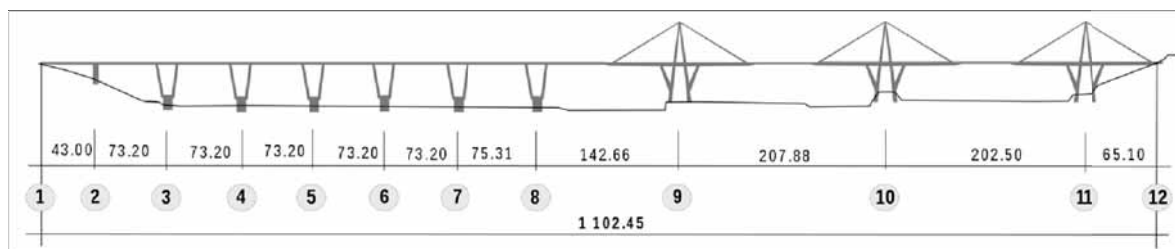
Schema prospettico delle 11 campate a partire dalla spalla terminale lato Savona.
